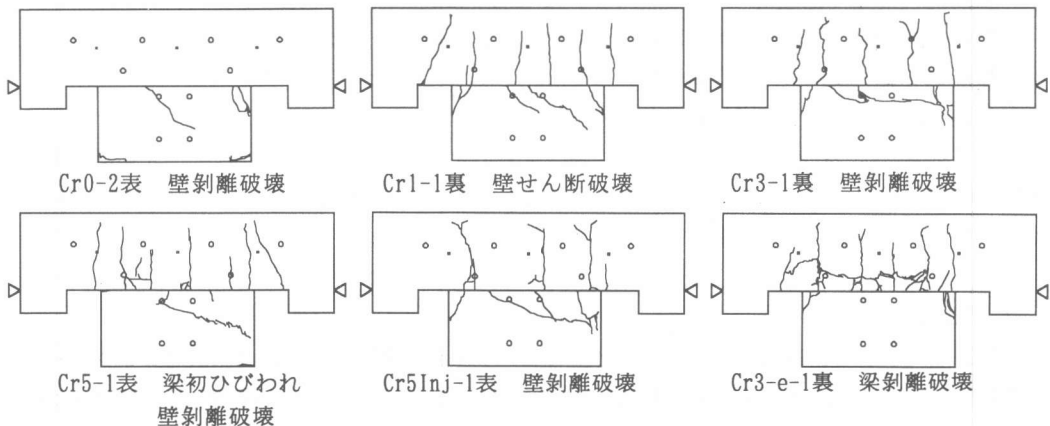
コンクリートの破壊形状 (表裏は図2平面図の下側を表とした)
